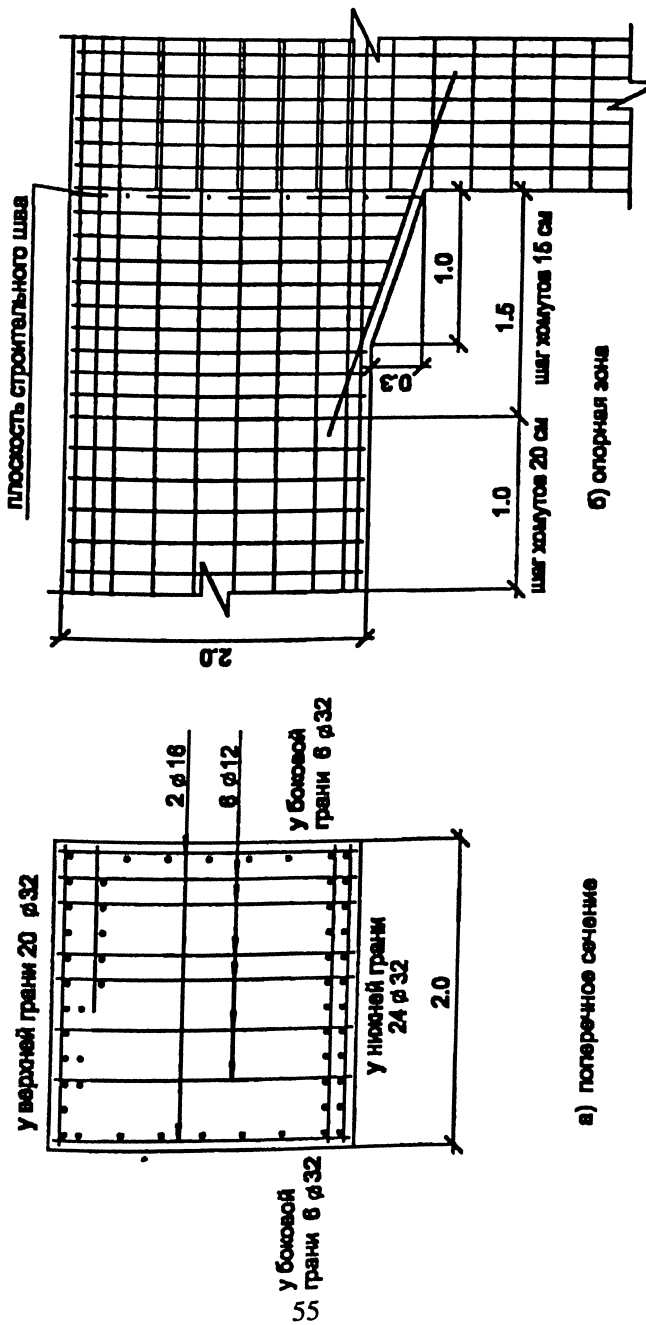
Схемы продольного и поперечного армирования подкрановой балки:
